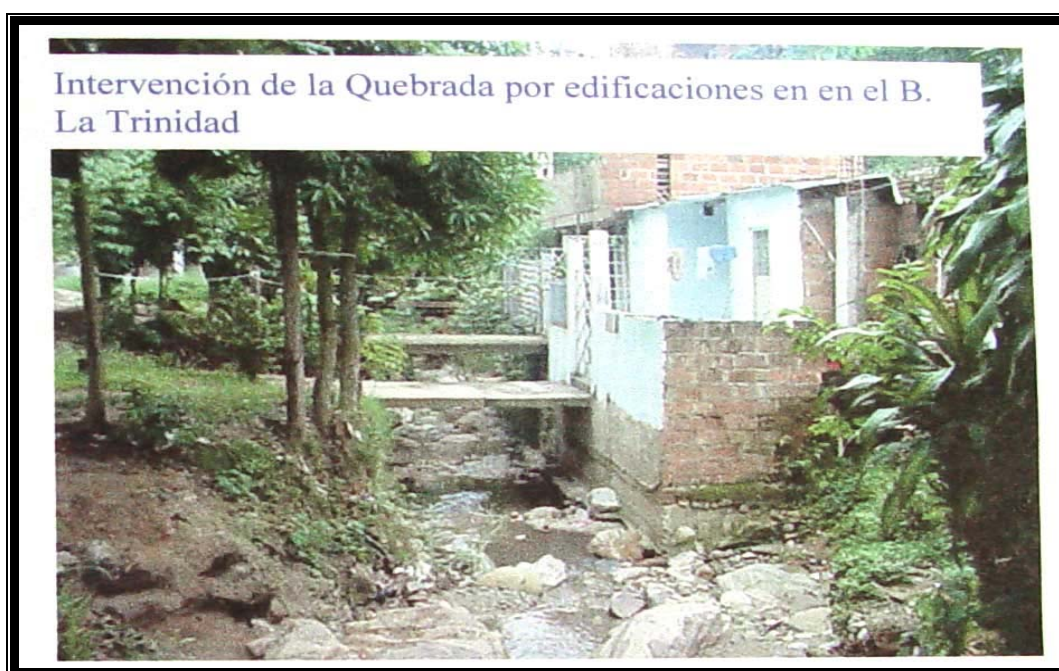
Fotografía de edificaciones sobre quebrada Barrio La Trinidad (fuente CDMB).
